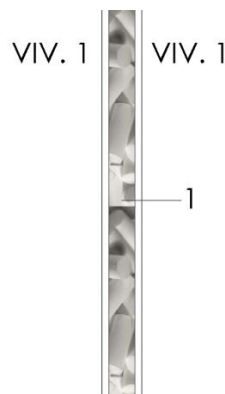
Detalle de tabiquería de distribución interior en las viviendas (sección vertical) con lana mineral en Málaga. Fuente: Elaboración propia
